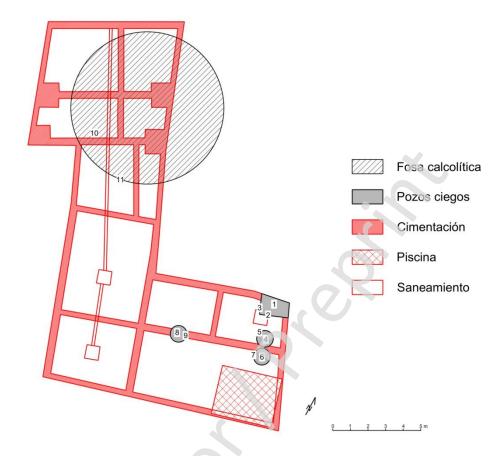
Planta del solar con las cimentaciones ejecutadas y ubicación de las estructuras arqueológicas.
